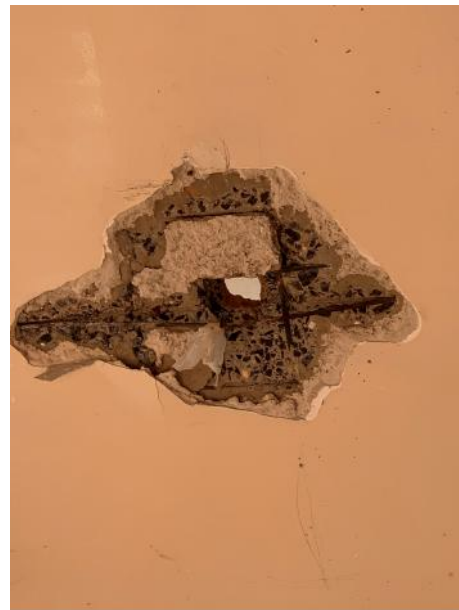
Armadura exposta e corroída; cobrimento deficiente; desagregação; deslocamento; falhas de concretagem.
